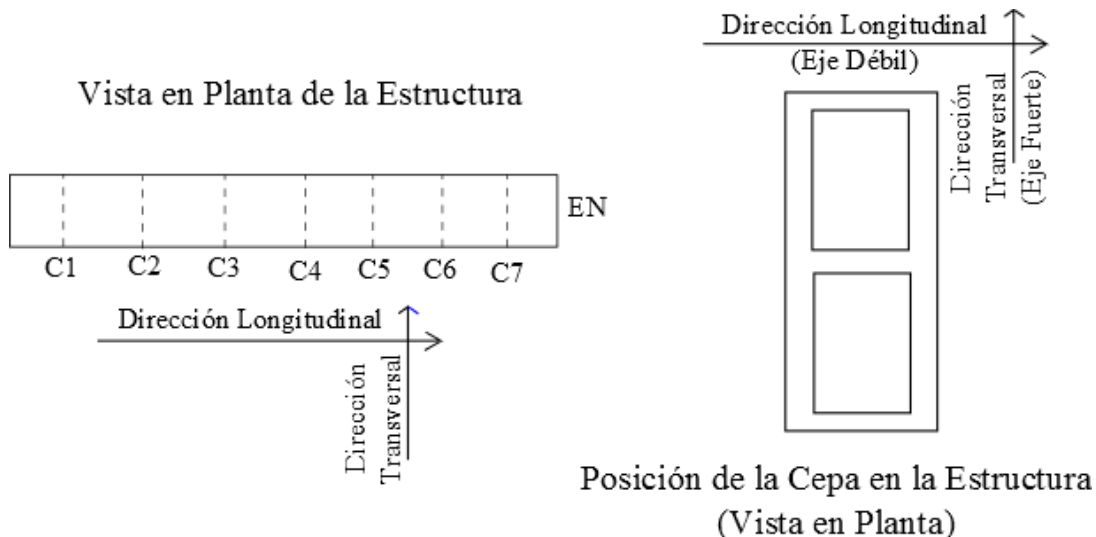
Direcciones principales en la estructura y en las cepas.
